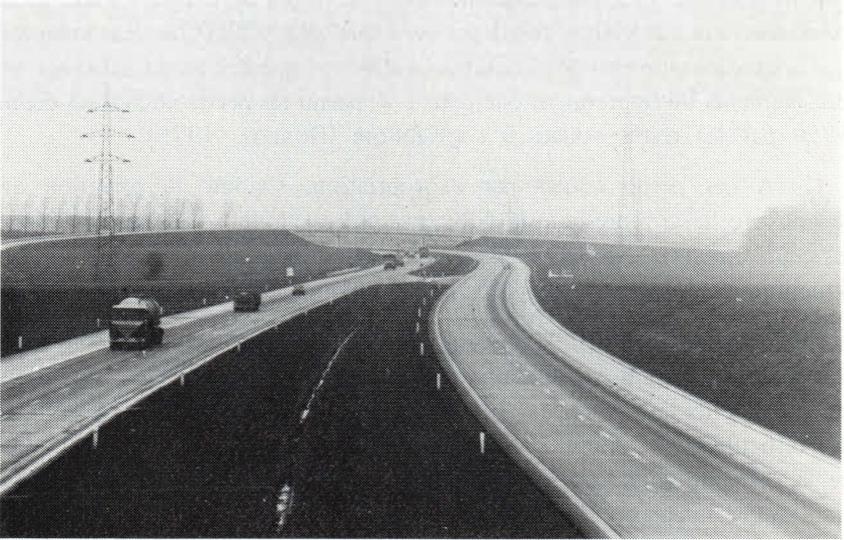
Dégénération du paysage, sur le plateau d'Hingon (autoroute E 41).
